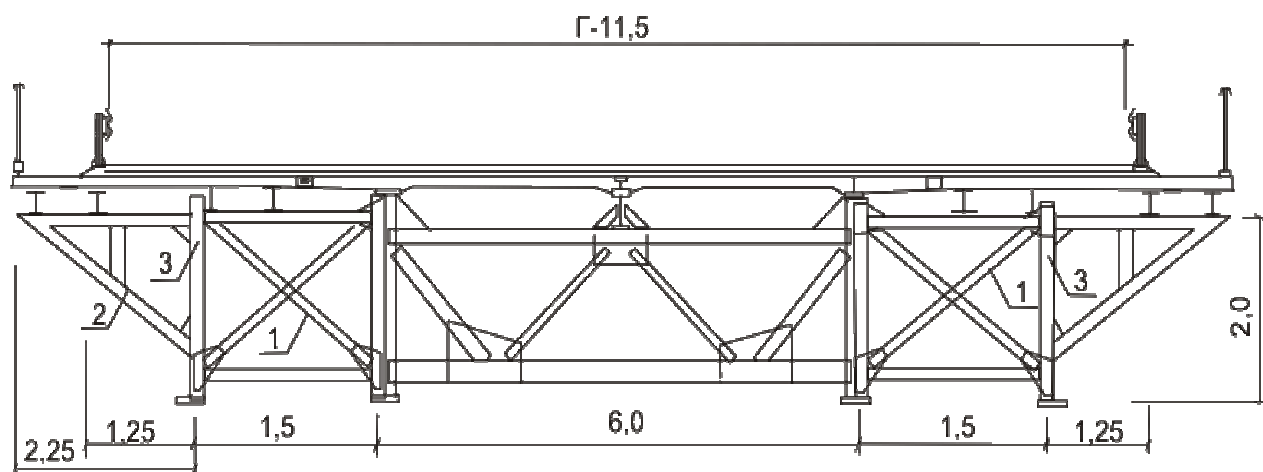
Уширение моста дополнительными главными балками и опорными столиками: 1 – дополнительная ферма; 2 – опорный столик; 3 – ребро жесткости
